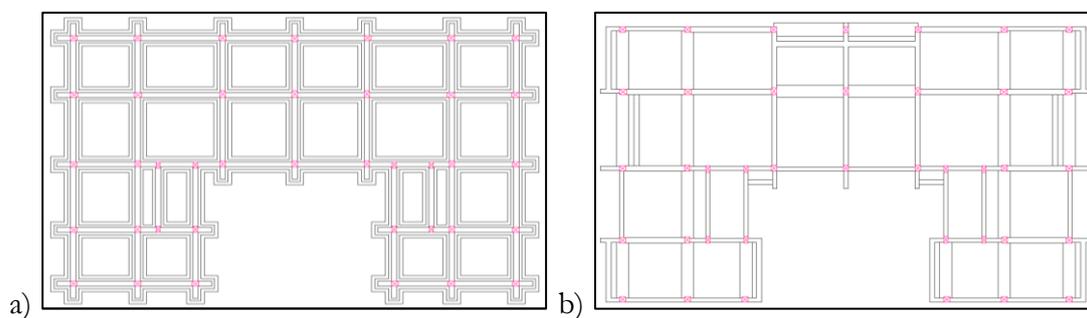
Pianta fondazione a) e pianta primo solaio b), ridisegnate su software CAD
